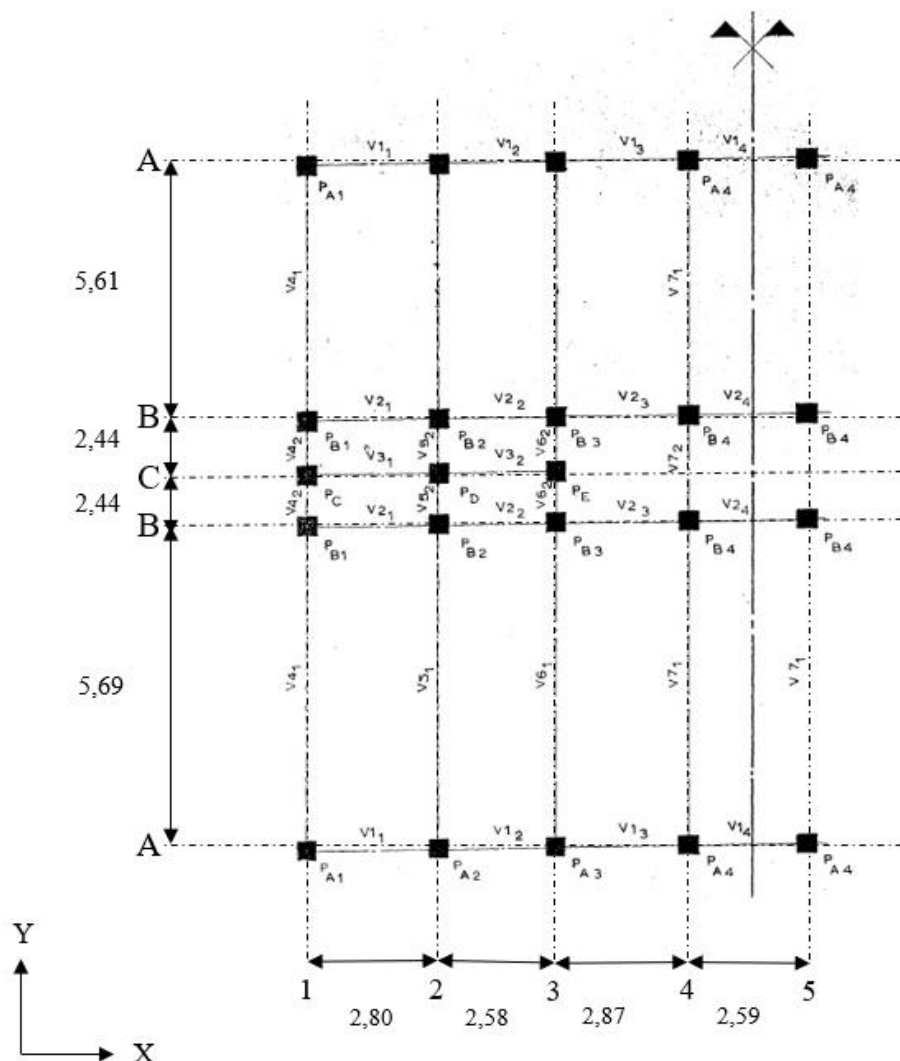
Planta da estrutura porticada de betão armado (embasamento) (ICESA, 1974).
